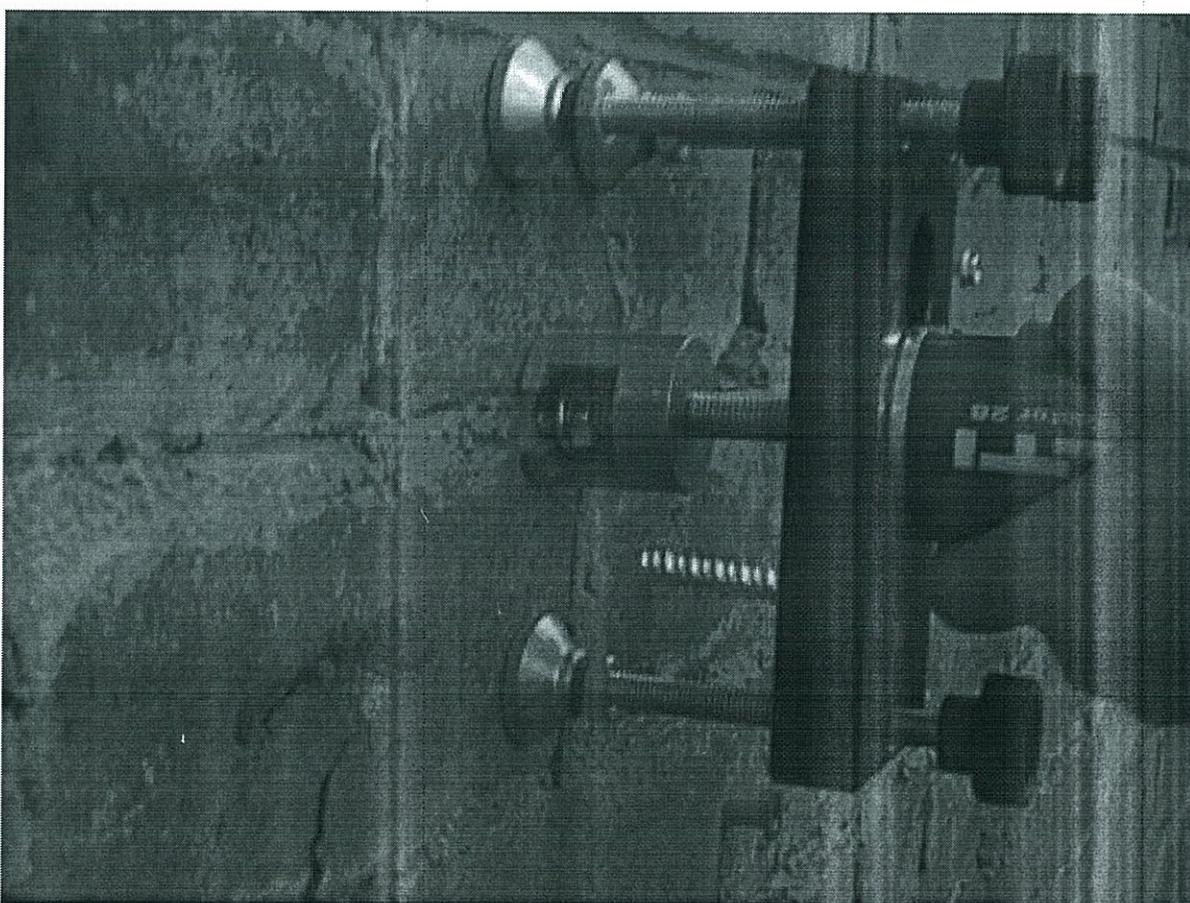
Испытание анкера марки HUS-N, закреплённого в горизонтальный растворный шов кладки из вибропрессованного бетонного кирпича
